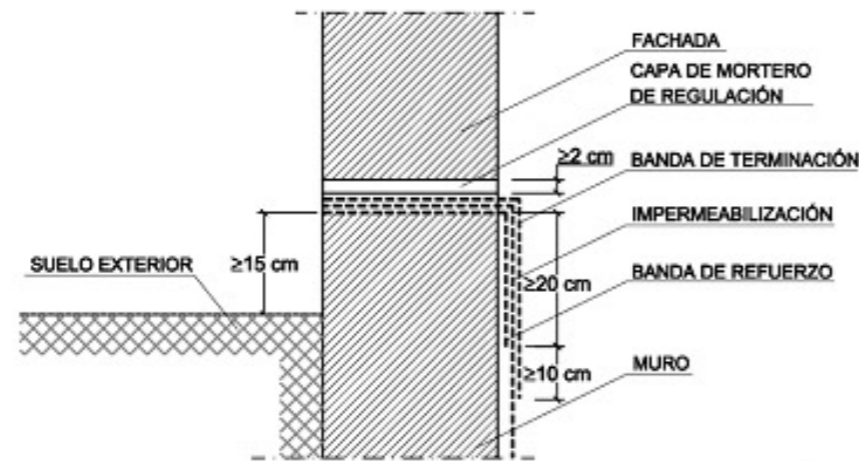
Ejemplo de encuentro de un muro impermeabilizado por el interior con lámina con una fachada
